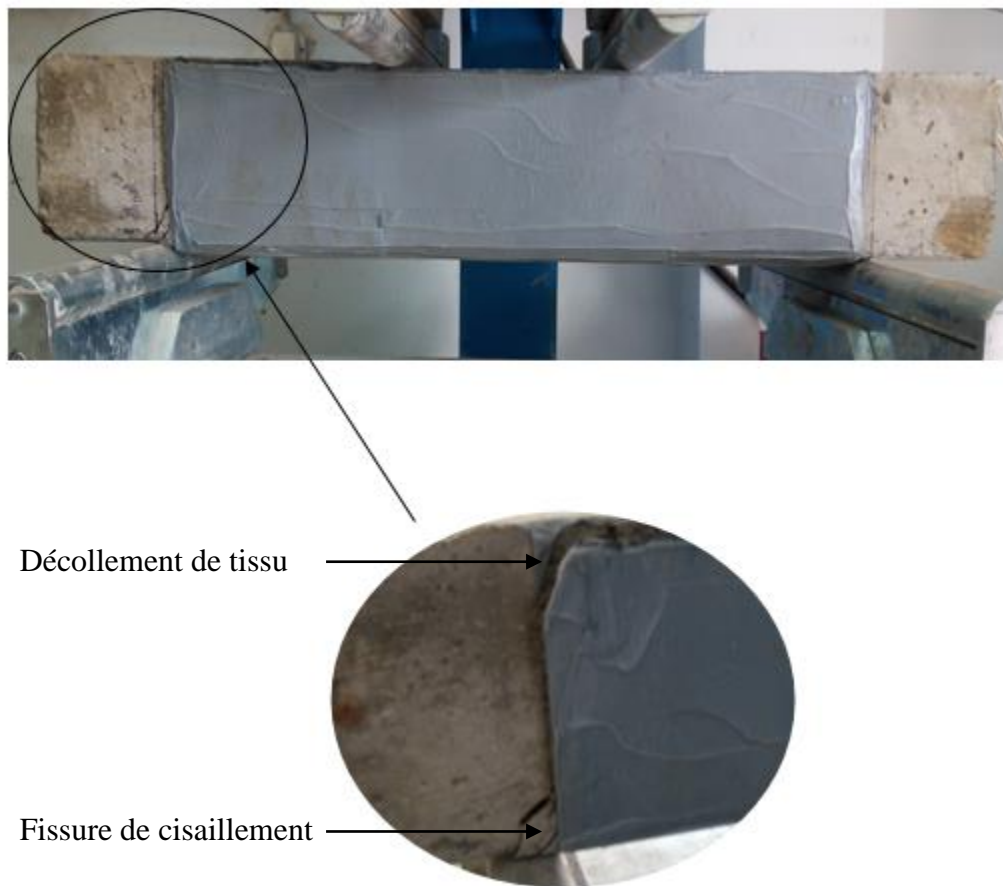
Rupture par cisaillement des poutres renforcées par la méthode mixte (M2)
